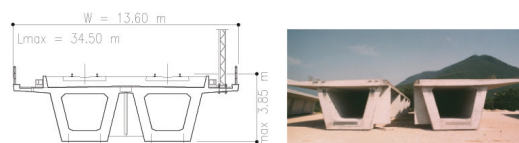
Impalcato bicassone in c.a.p. (viadotto S. Rocco al Porto). *Pre-stressed reinforced concrete 2-boxes deck (S. Rocco al Porto viaduct)*.
